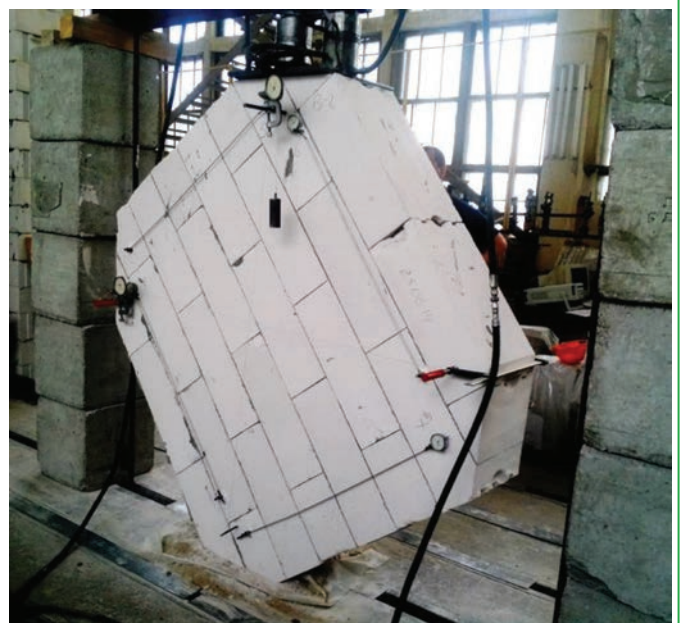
Общий вид испытаний фрагмента кладки на перекос.
